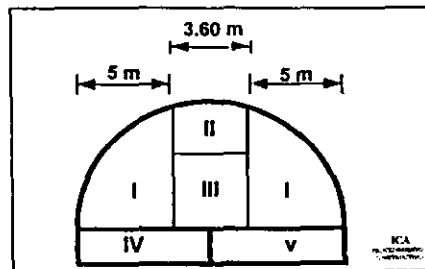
Sección, dividida en dos laterales I, un pilastrón central (II y III) e inferiores (IV y V).
